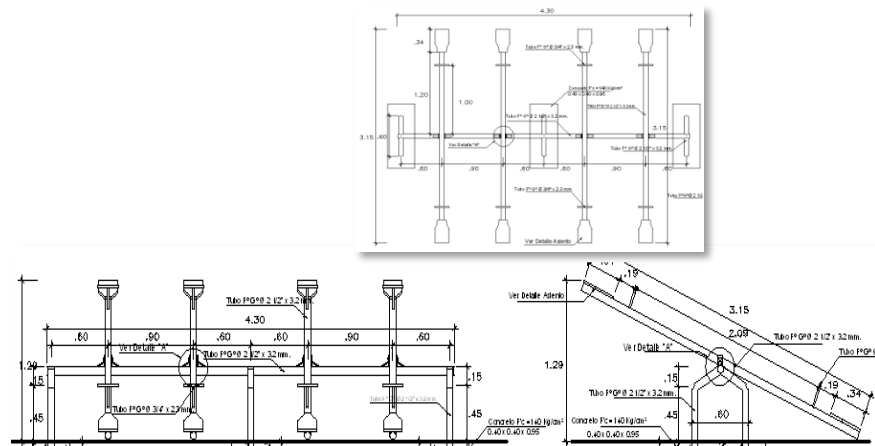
Dibujo en planta, elevación frontal y elevación lateral del juego recreativo Sube y Baja. Fuente: Ernst Neufert (*El arte de proyectar en arquitectura*)
